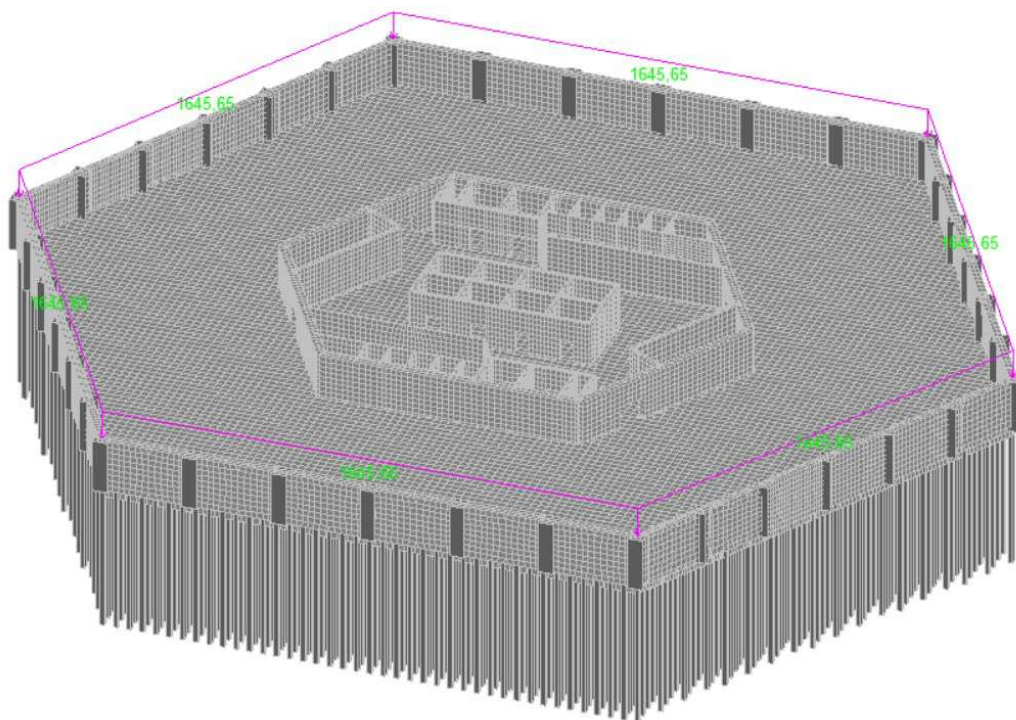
Схема приложения нагрузки на внешние стены
